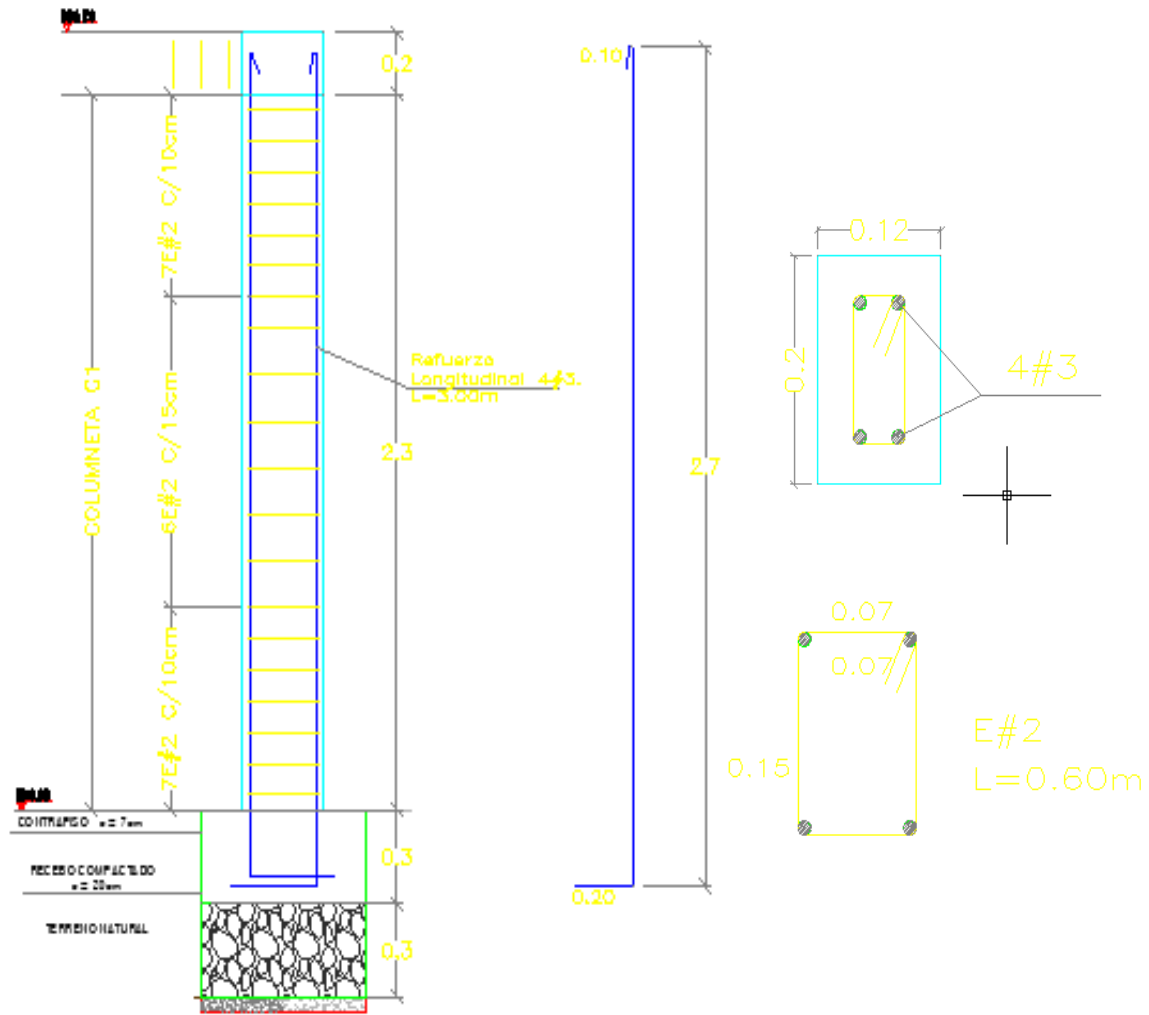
Columnetas tipo 1 AUTOCAD.
